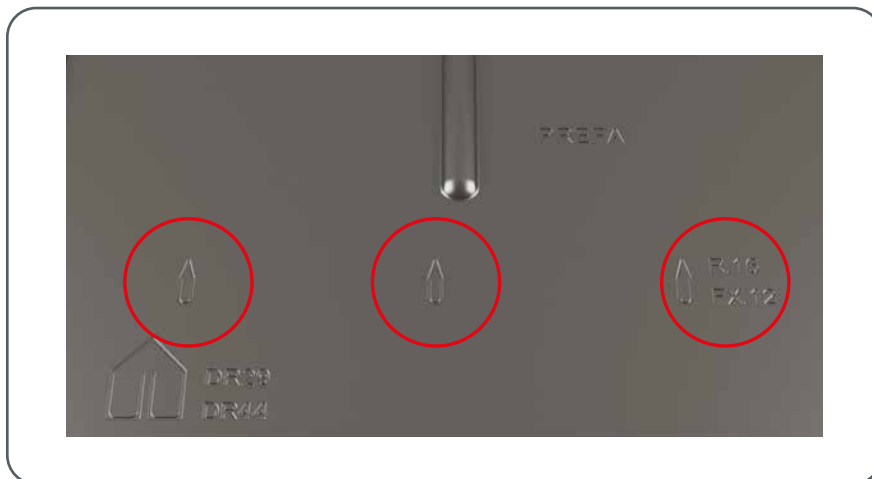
• Saumstreifen – Markierungen für Dachplatte R.16 und Fassadenpaneel FX.12
